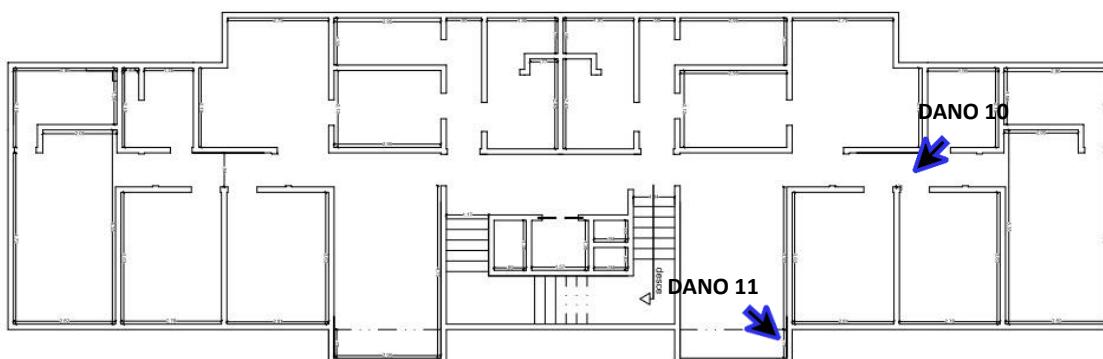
Planta Baixa (croqui) do Pavimento do 1º andar – Bloco A – Cond. Armando Lôbo.
